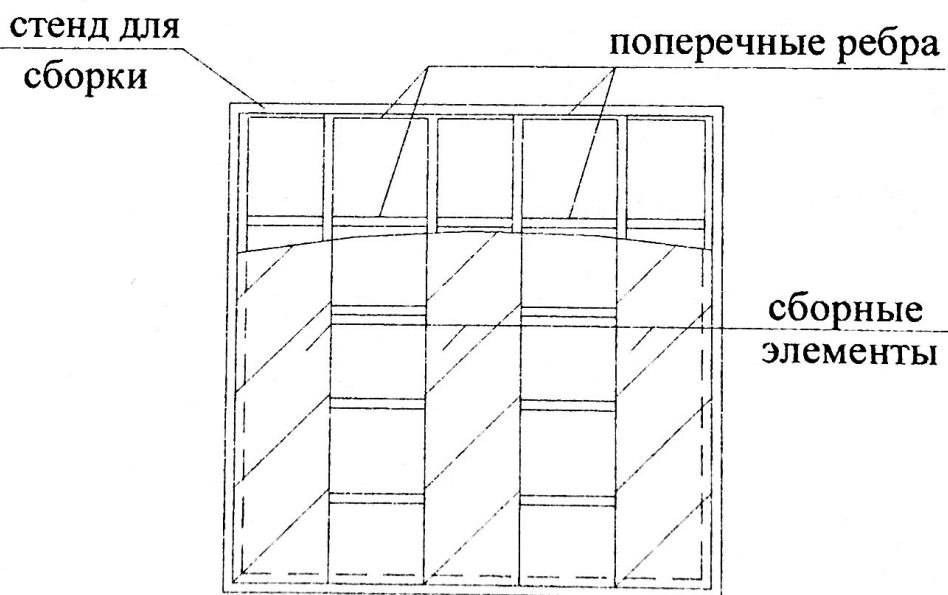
Схема стенда для сборки одного лепестка составной оболочки.
